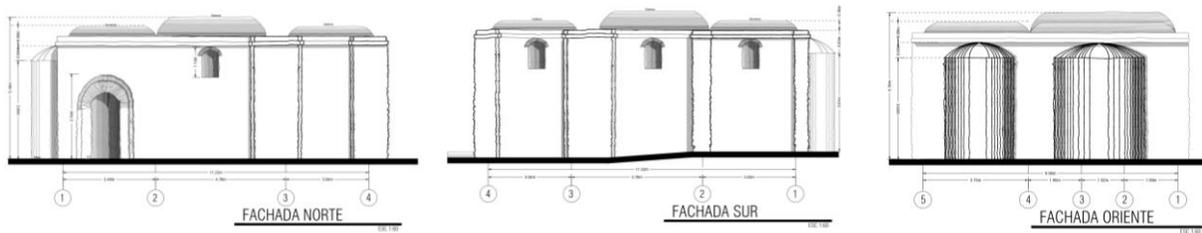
Fachadas norte, sur y oriente del estado actual de la Casa de Éfeso. (Elaboración propia, 2021)
